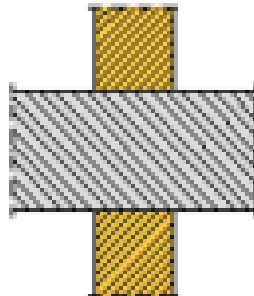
Detalle unión rígida (herramienta oficial de cálculo del CTE)
